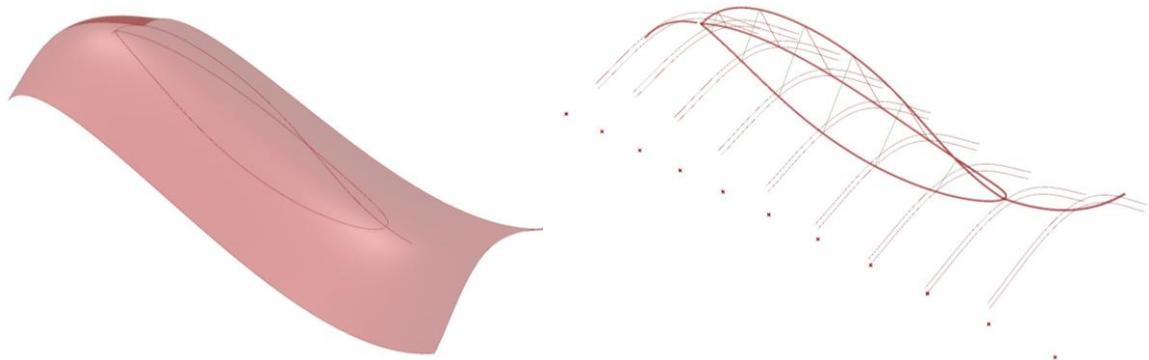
Superficie y ejes estructurales. Viga principal y secciones transversales
